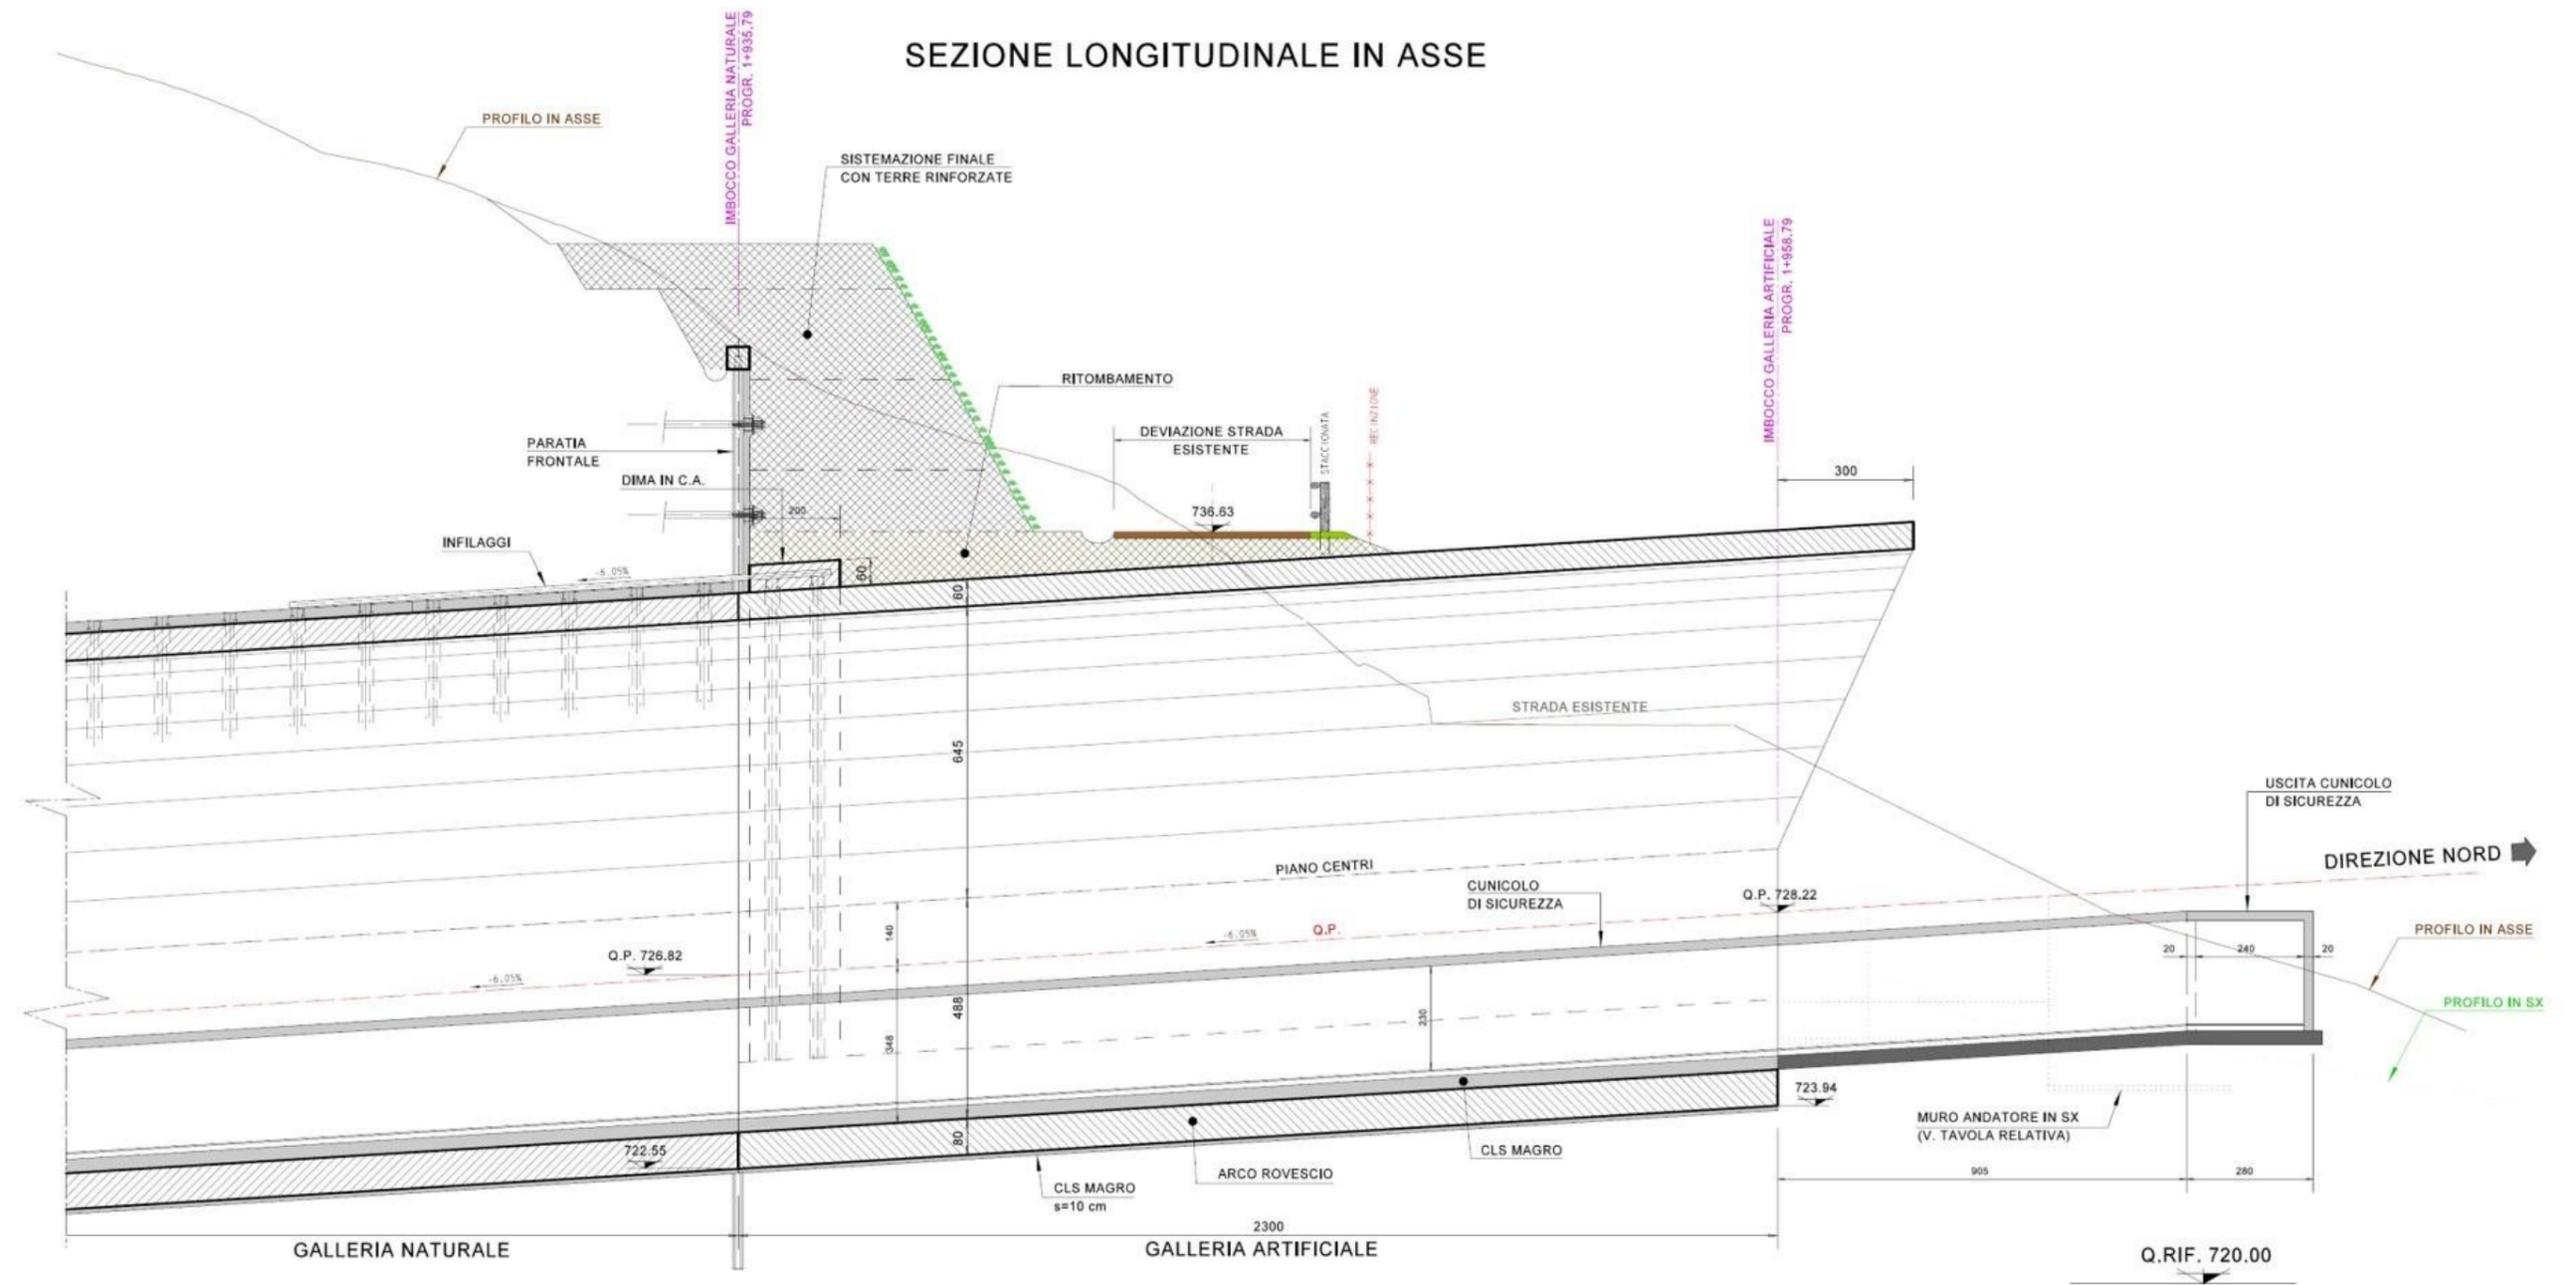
Galleria naturale Imbocco – Paratie berlinesi – Sistemazione finale - Profilo in asse galleria
